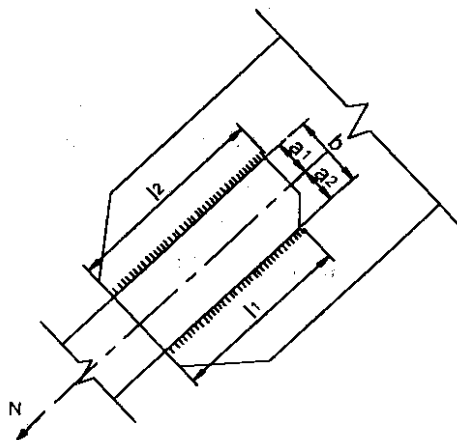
Sơ đồ tính thanh giằng, bản giằng, bản khoét lỗ.
